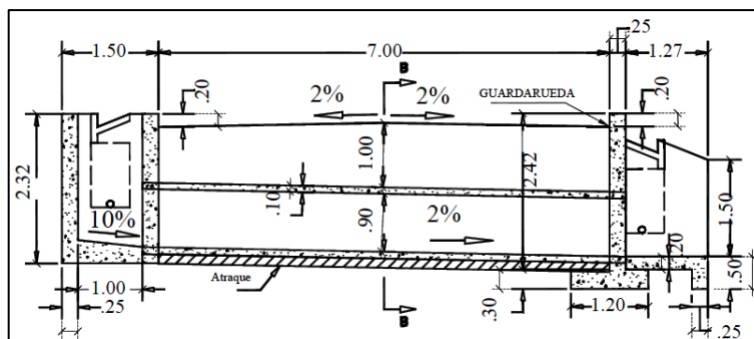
Corte A-A' de las estructuras hidráulicas a construir en el proyecto de Málaga-Santander
